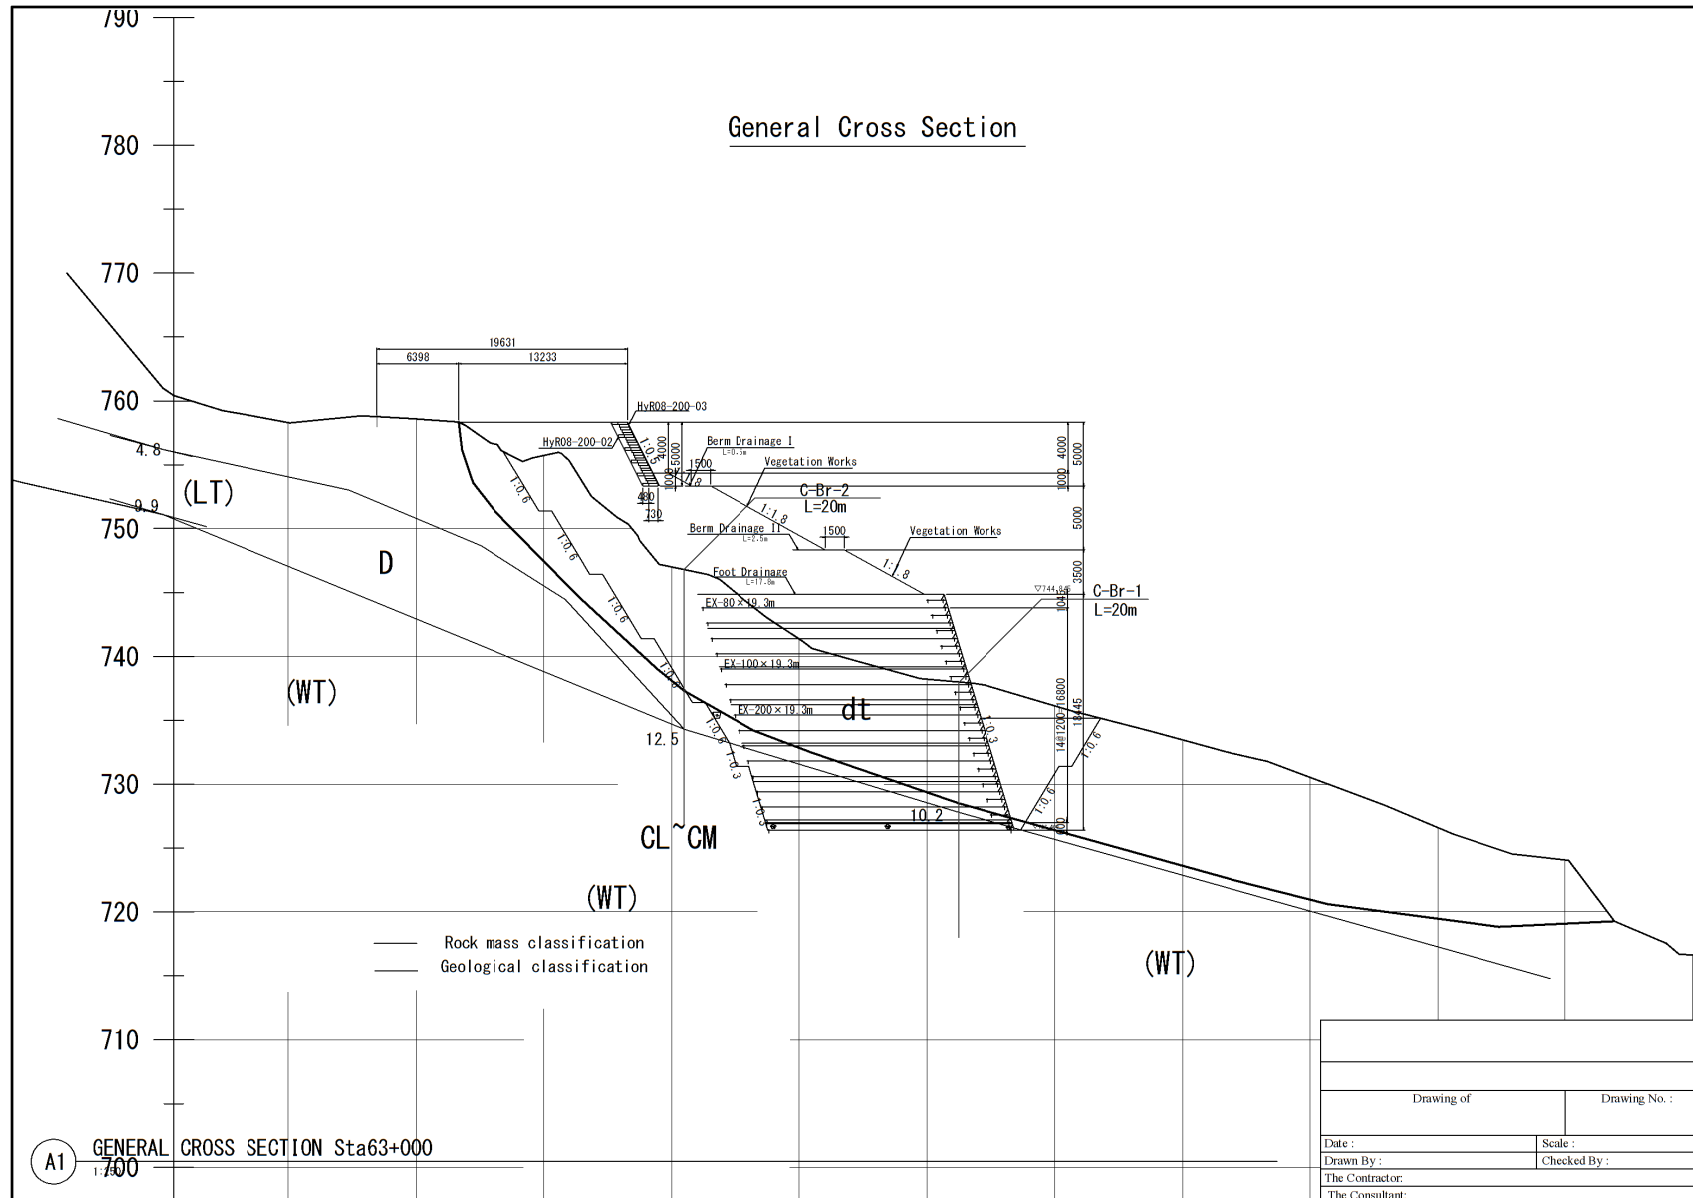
Sta. 63+000 標準断面図 (Non-Scale)
